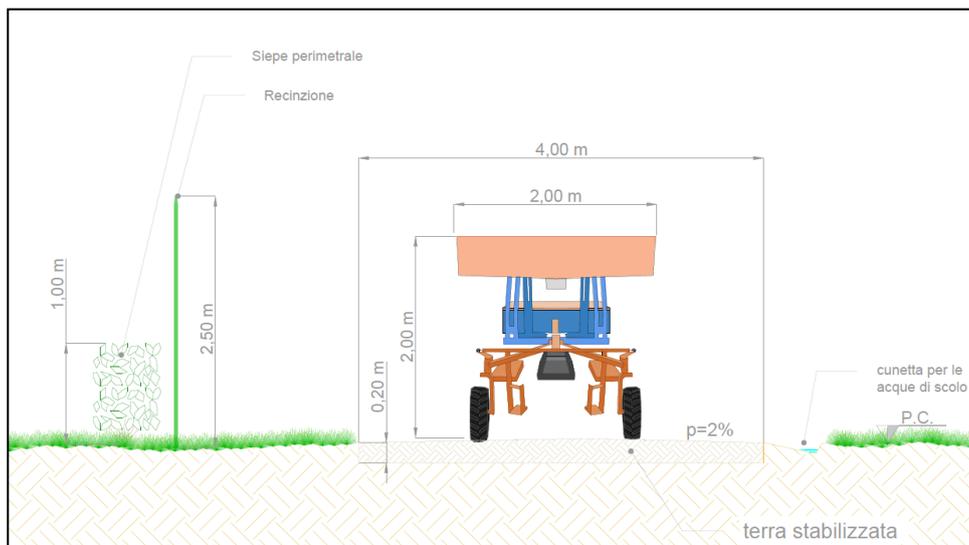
Dettaglio costruttivo delle strade per la viabilità interna al sito di installazione dell'impianto fotovoltaico
